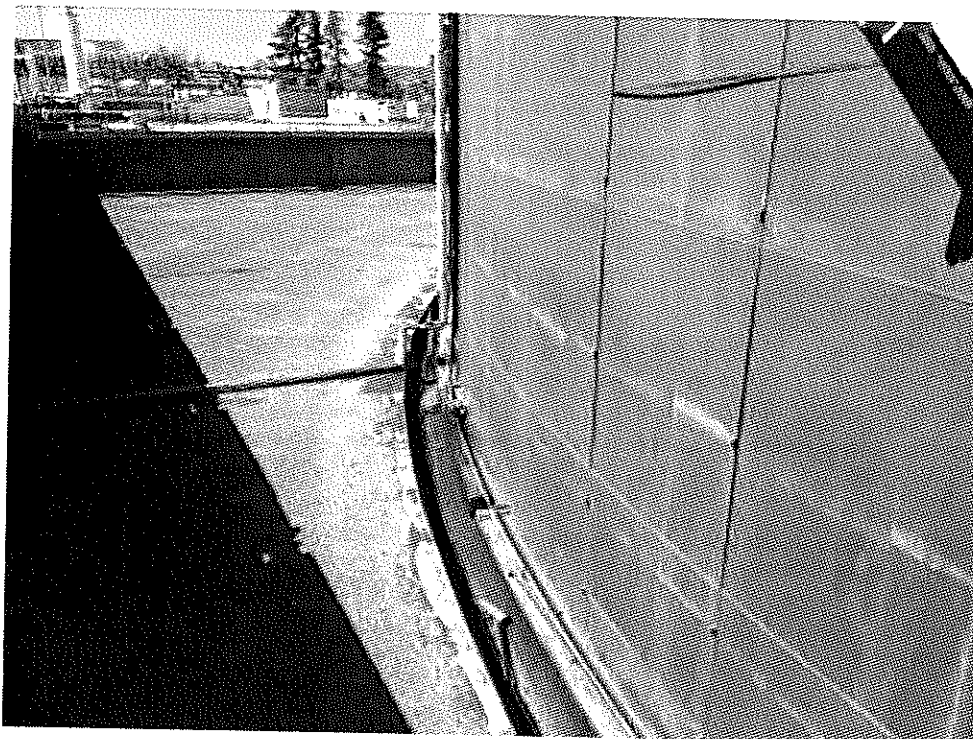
Serbatoio BTX a tetto galleggiante - particolare bacino di contenimento
